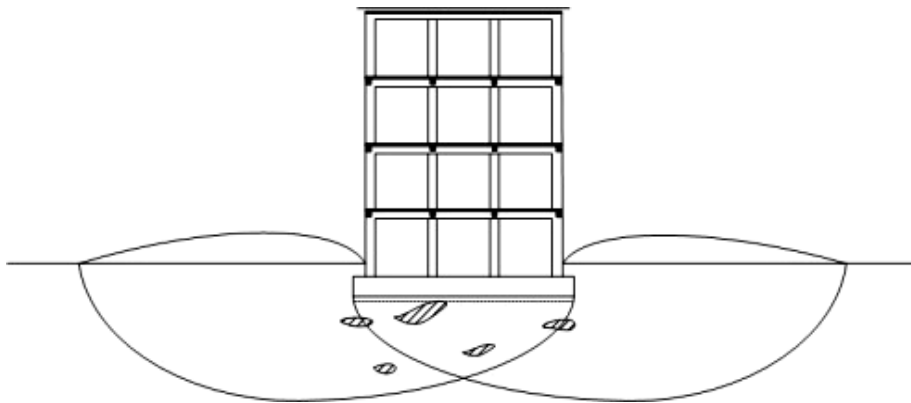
Structuri de beton armat în cadre, cu fundație pe radier general
